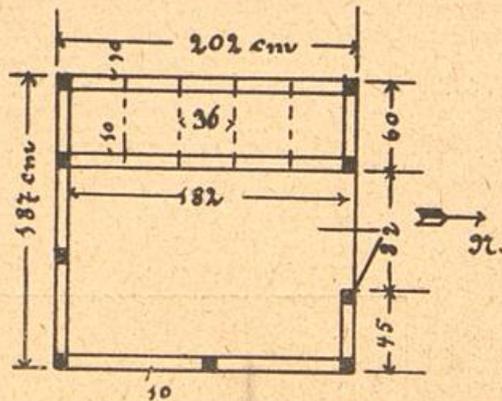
Grundriß zum Bienenhaus für 10 Thür. Einbeuten Nr. 1 oder 2 mit vertieftem Behandlungsraum.
